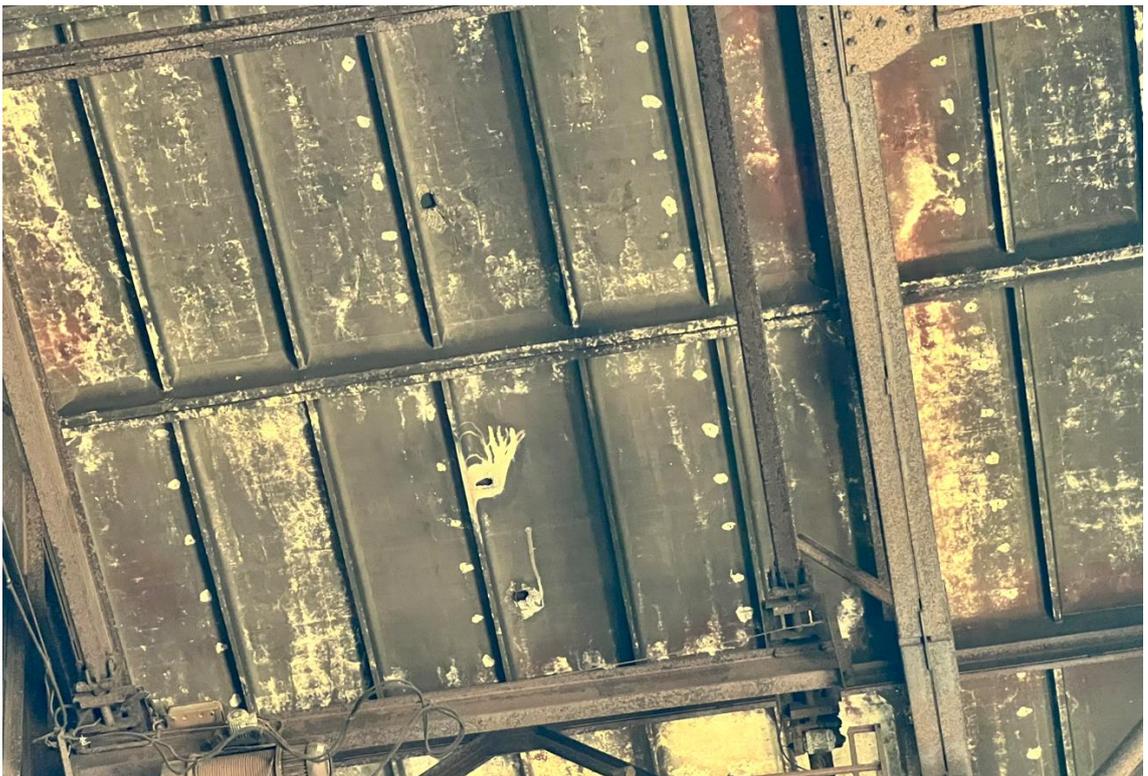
Выщелачивание бетона, отверстия в плитах покрытия. Сколы защитного слоя плиты от механического крепления кровельной мембраны
